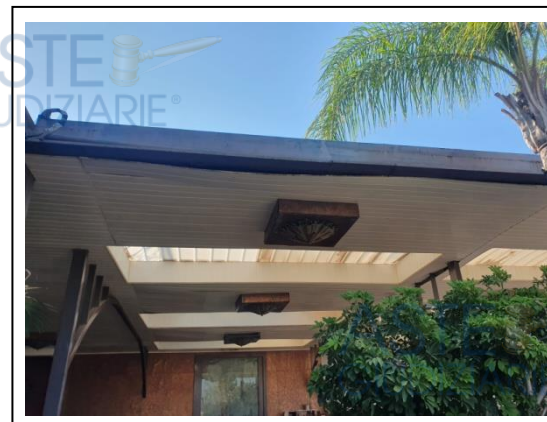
ammaloramento della struttura metallica della copertura della terrazza di primo piano
